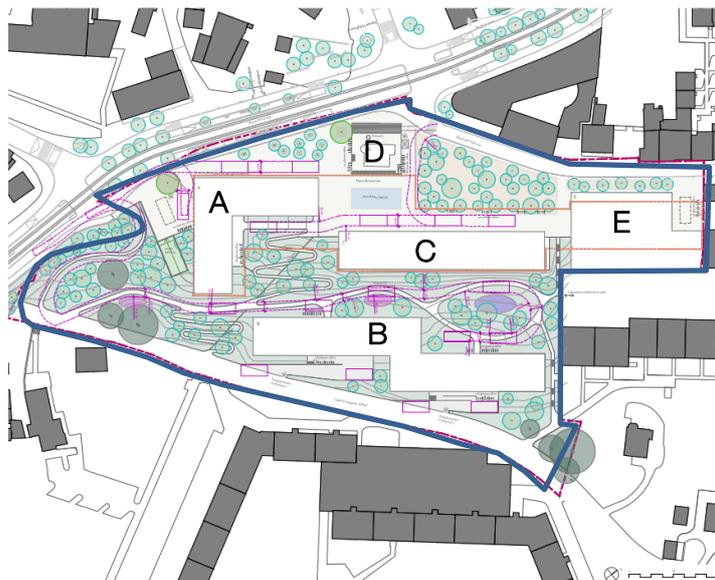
Plan masse (source : Hager, mars 2022) En bleu, le PLQ Carantec
